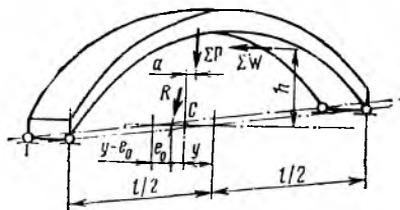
Схема к расчету арочных кружал на устойчивость против опрокидывания
